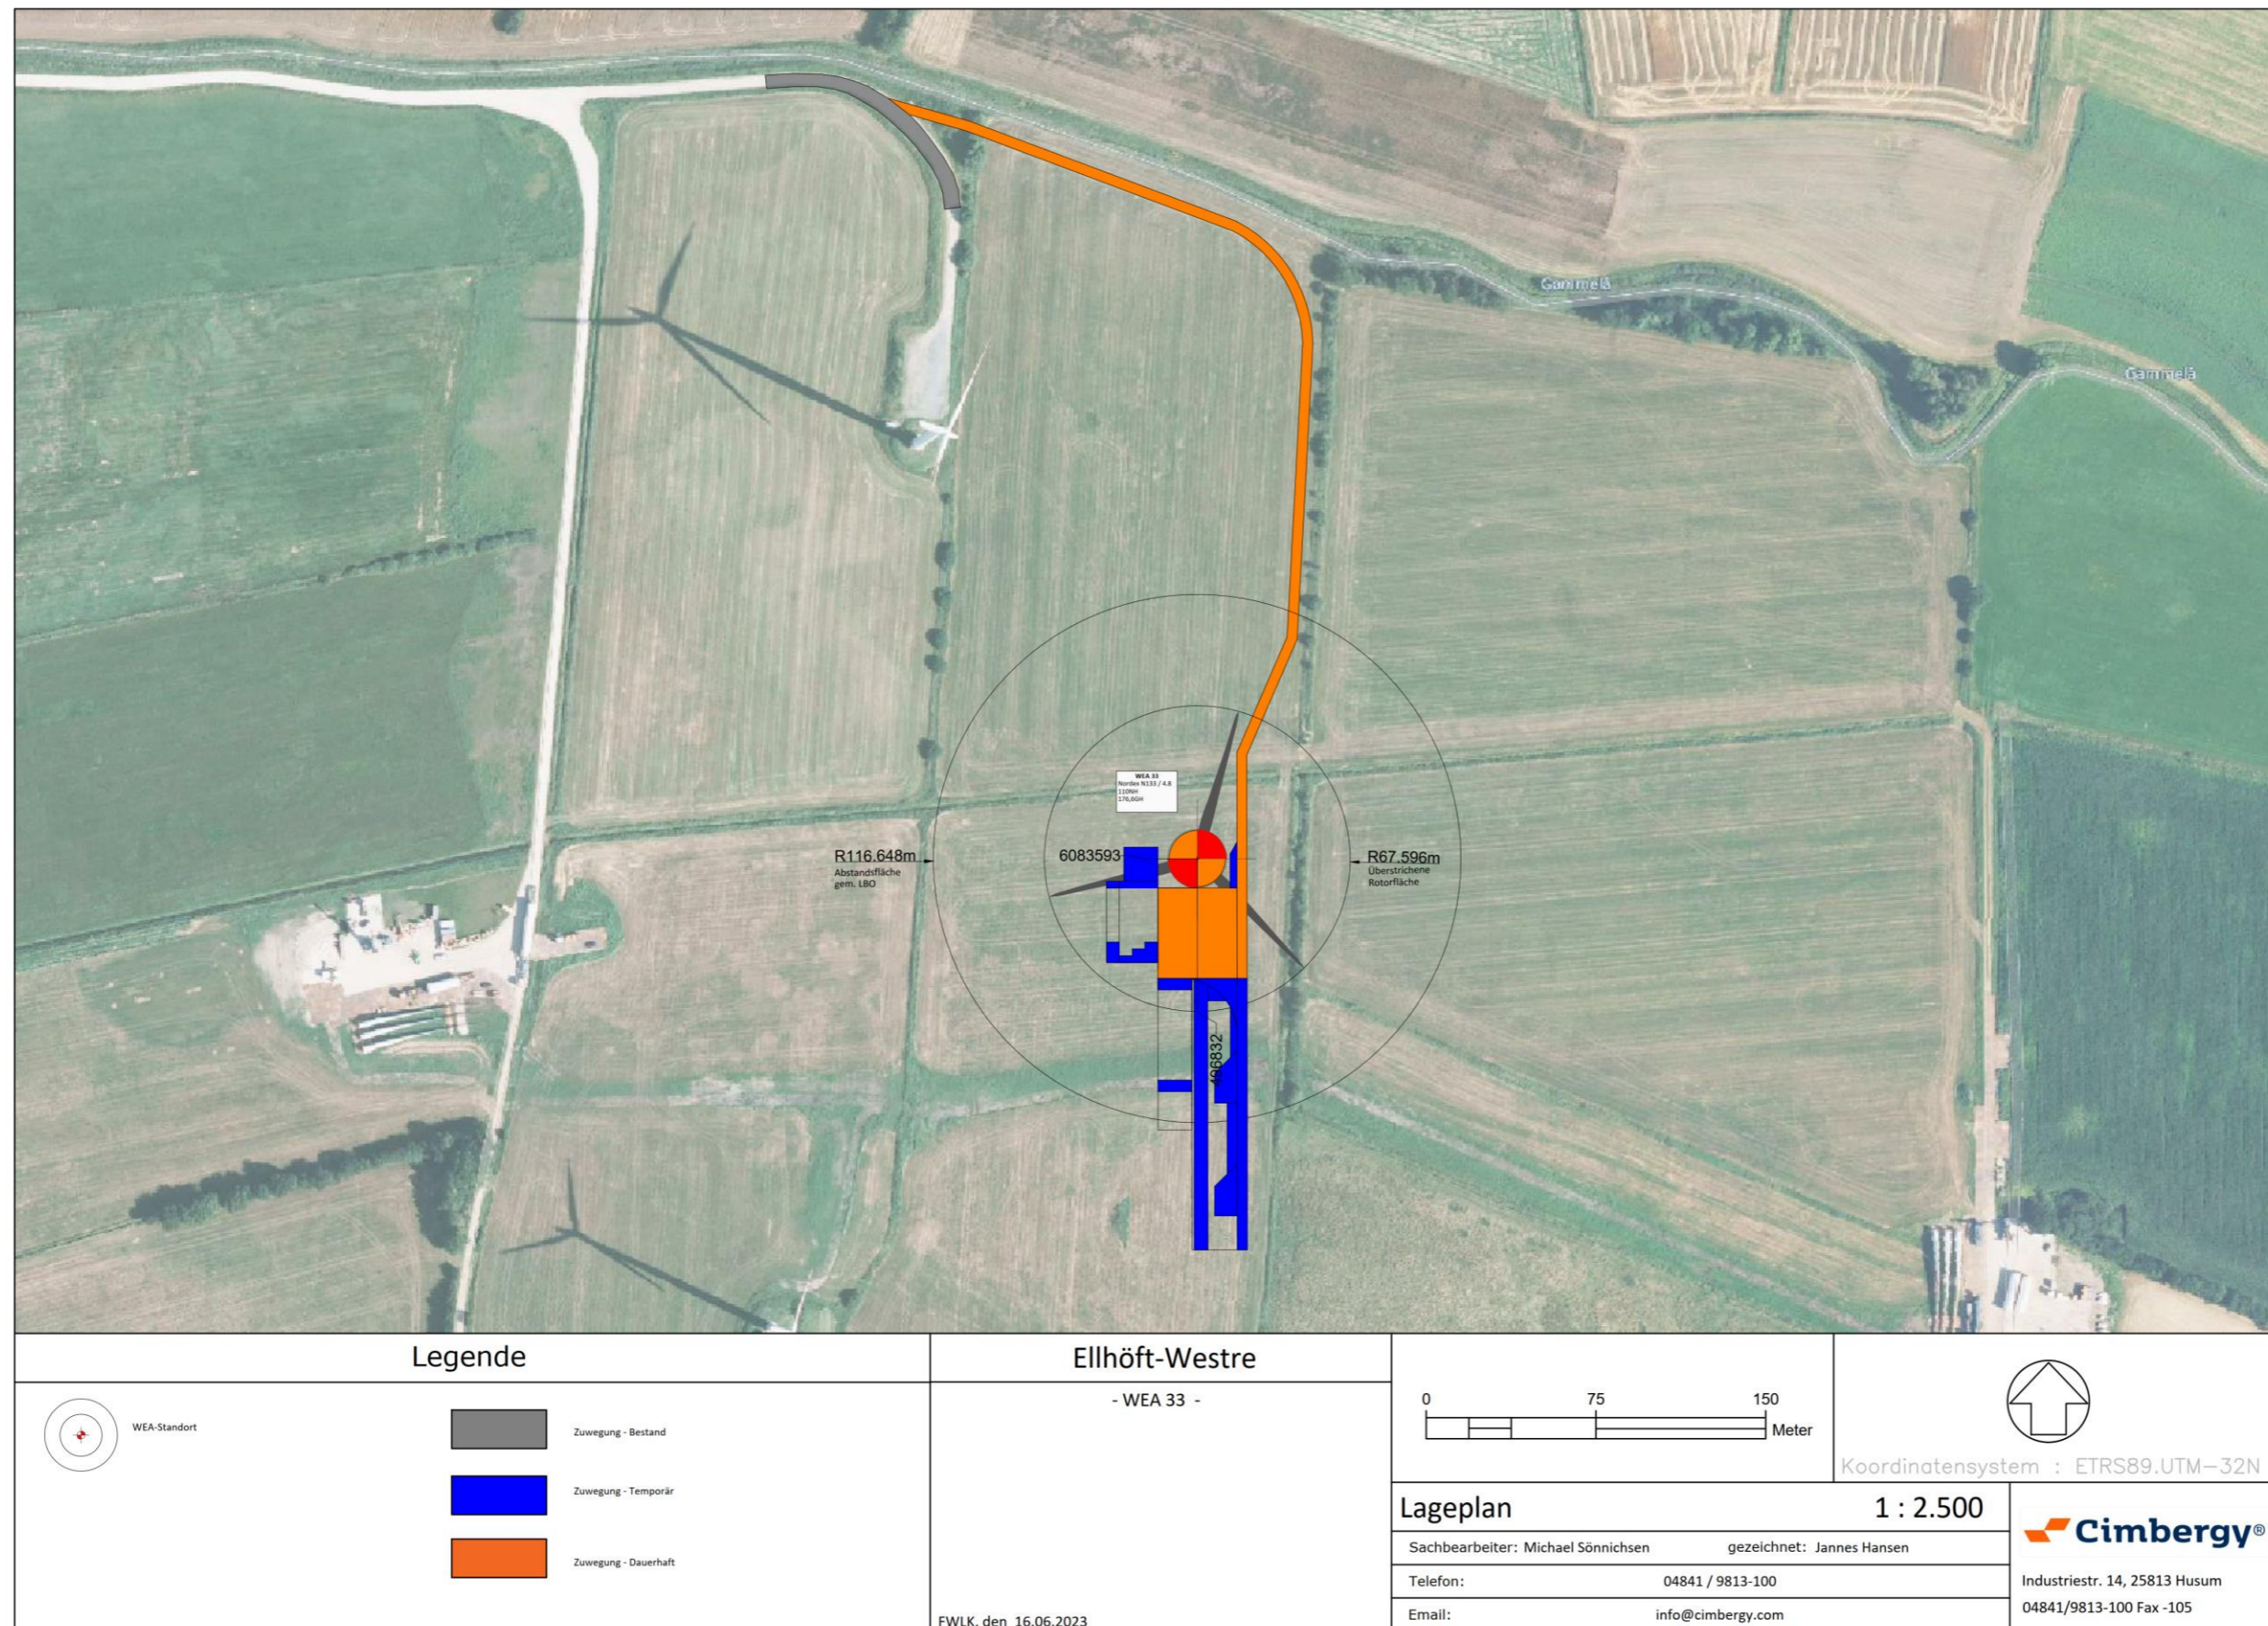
Planlægning af placering og adgang VEA 33 (Kilde: Cimbergy; sidst ændret: 16-06-2023)
